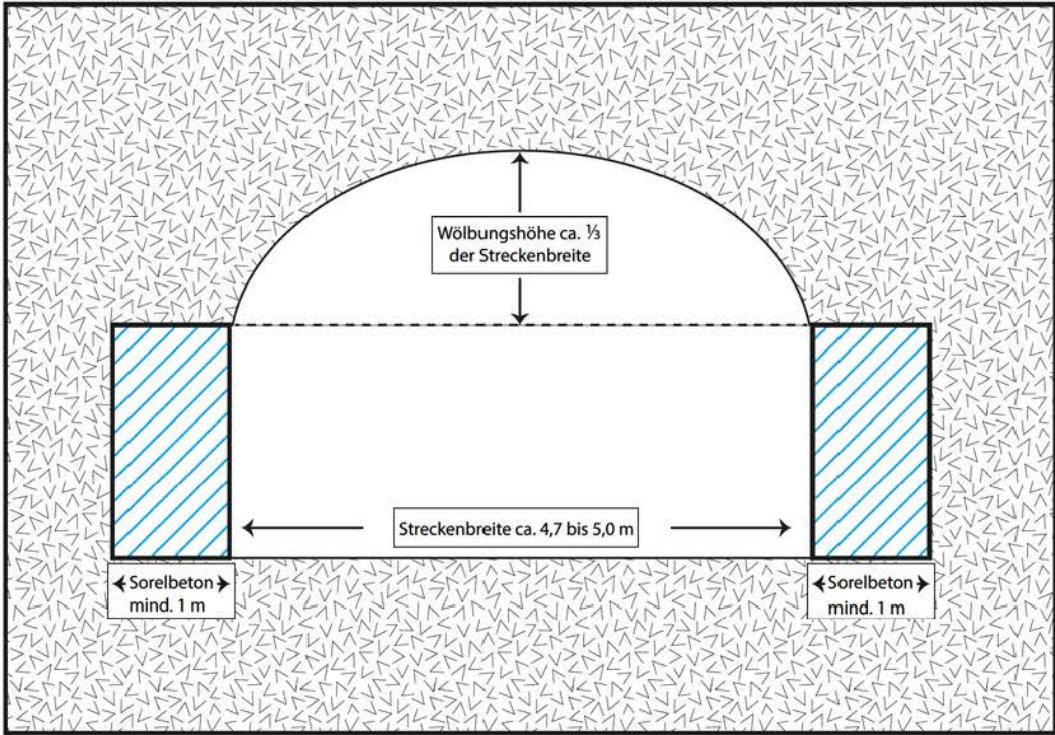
Querschnitt eines sanierten Wendelstreckenabschnitts mit Sorelbeton-Stabilisierungsmauern an den Stößen und einer stabilen Firstwölbung
